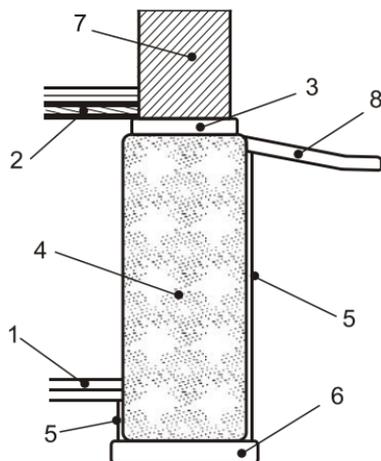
Устройство гидроизоляции в здании с подвалом при отсутствии грунтовых вод: 1 — пол подвала; 2 — перекрытие надподвальное; 3 — горизонтальная гидроизоляция; 4 — фундамент; 5 — вертикальная гидроизоляция; 6 — подошва фундамента; 7 — стена; 8 — отмостка
